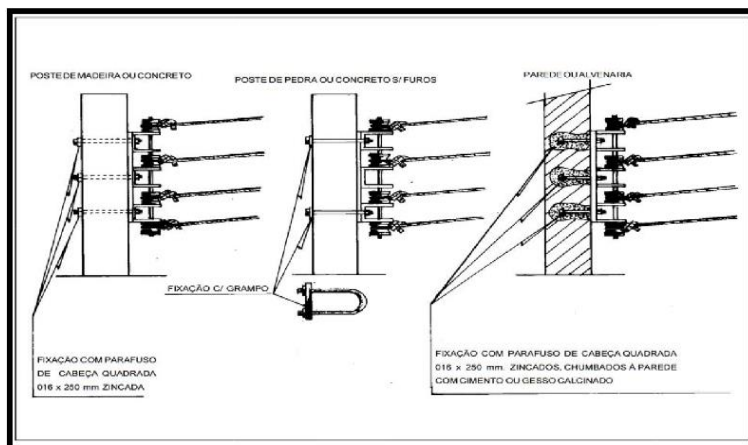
Fixação da rede com armação secundária e isolador tipo roldana em poste ou parede
